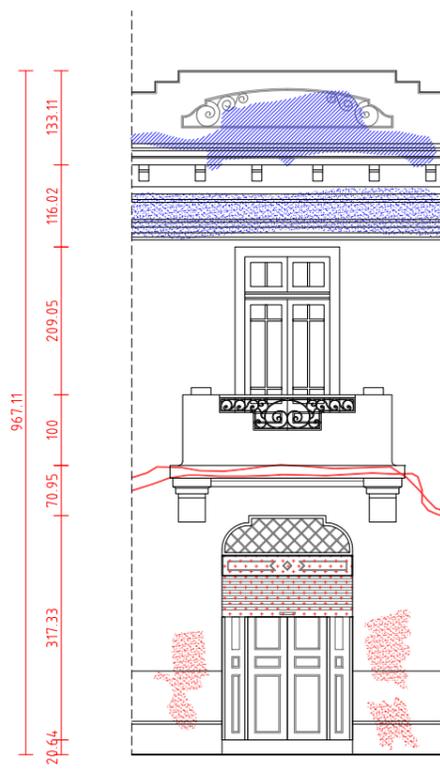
Fachada del inmueble desde Av. Matta. Fuente: Fot. autores (2014).
